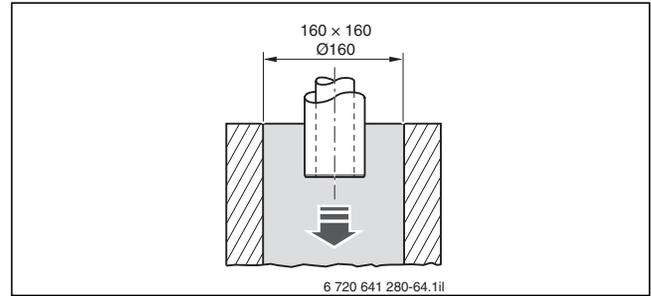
Mindestmaße des Schachtquerschnitts für die Montage der Luft-Abgas-Leitung (Maße in mm)
